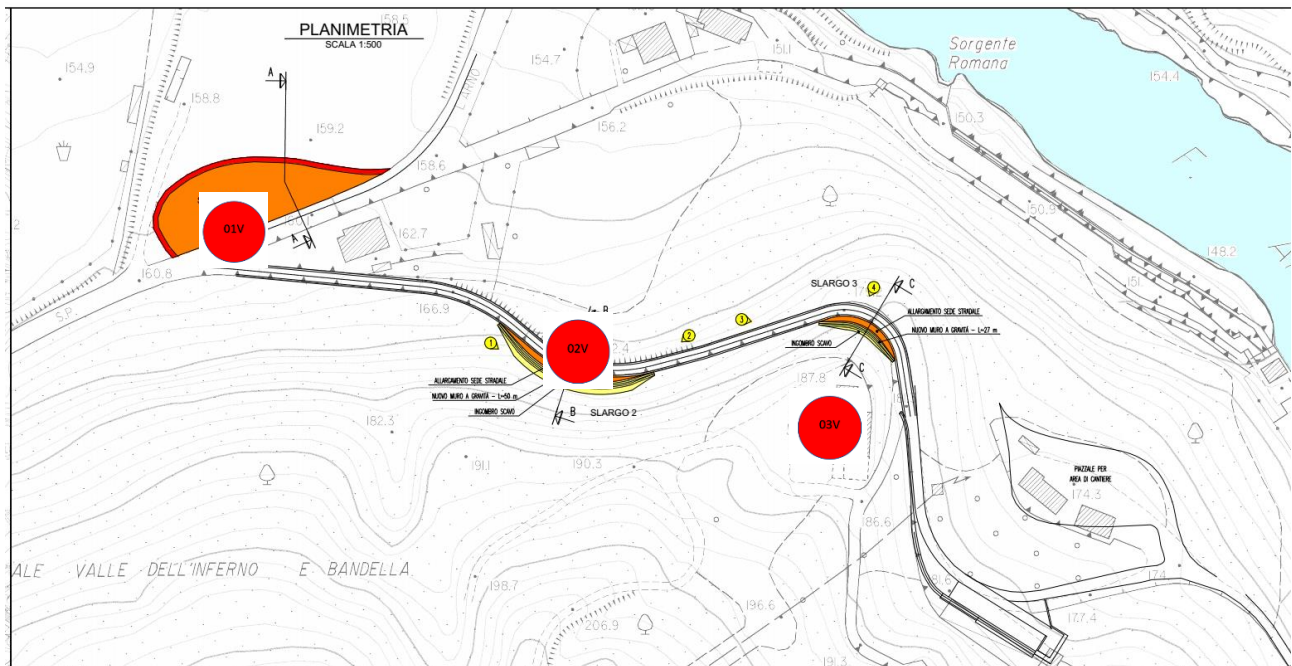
1 – PD - INQUADRAMENTO PLANIMETRICO VIABILITA' ACCESSO
